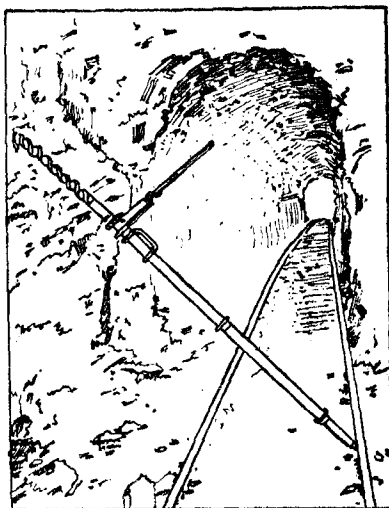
Trabajo de la perforadora en posición inclinada con punto de apoyo.
